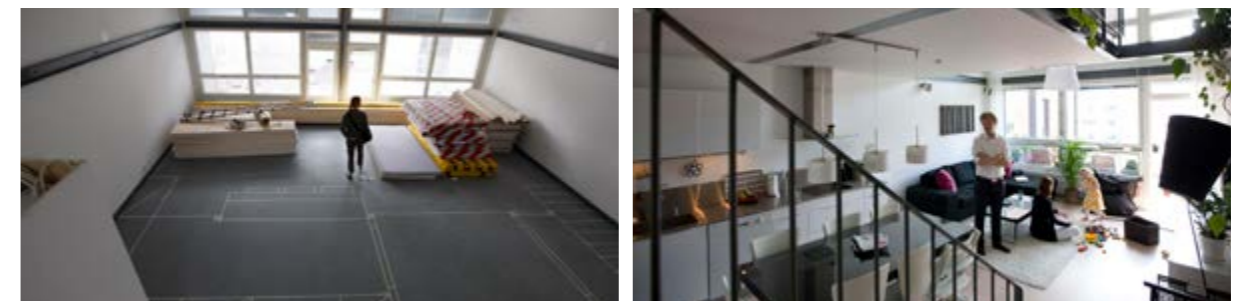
Tila Housing Block, Talli Architecture & Design, Helsinki. La hauteur libre peut (partiellement) être divisée en deux niveaux au moyen de sections de plancher amovibles. (Source : Architect : Pia Ilonen, Ilo arkkitehdit Oy www.iloark.fi. Photos : Stefan Bremer)
